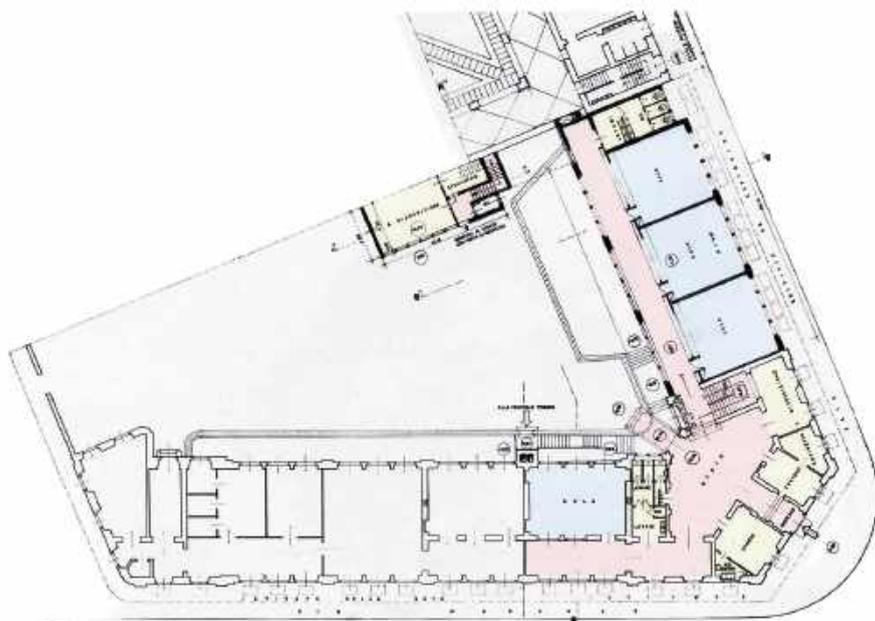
Pianta piano terra (rielaborazione, rosso-spazi distributivi, giallo-servizi, blu-aule)
